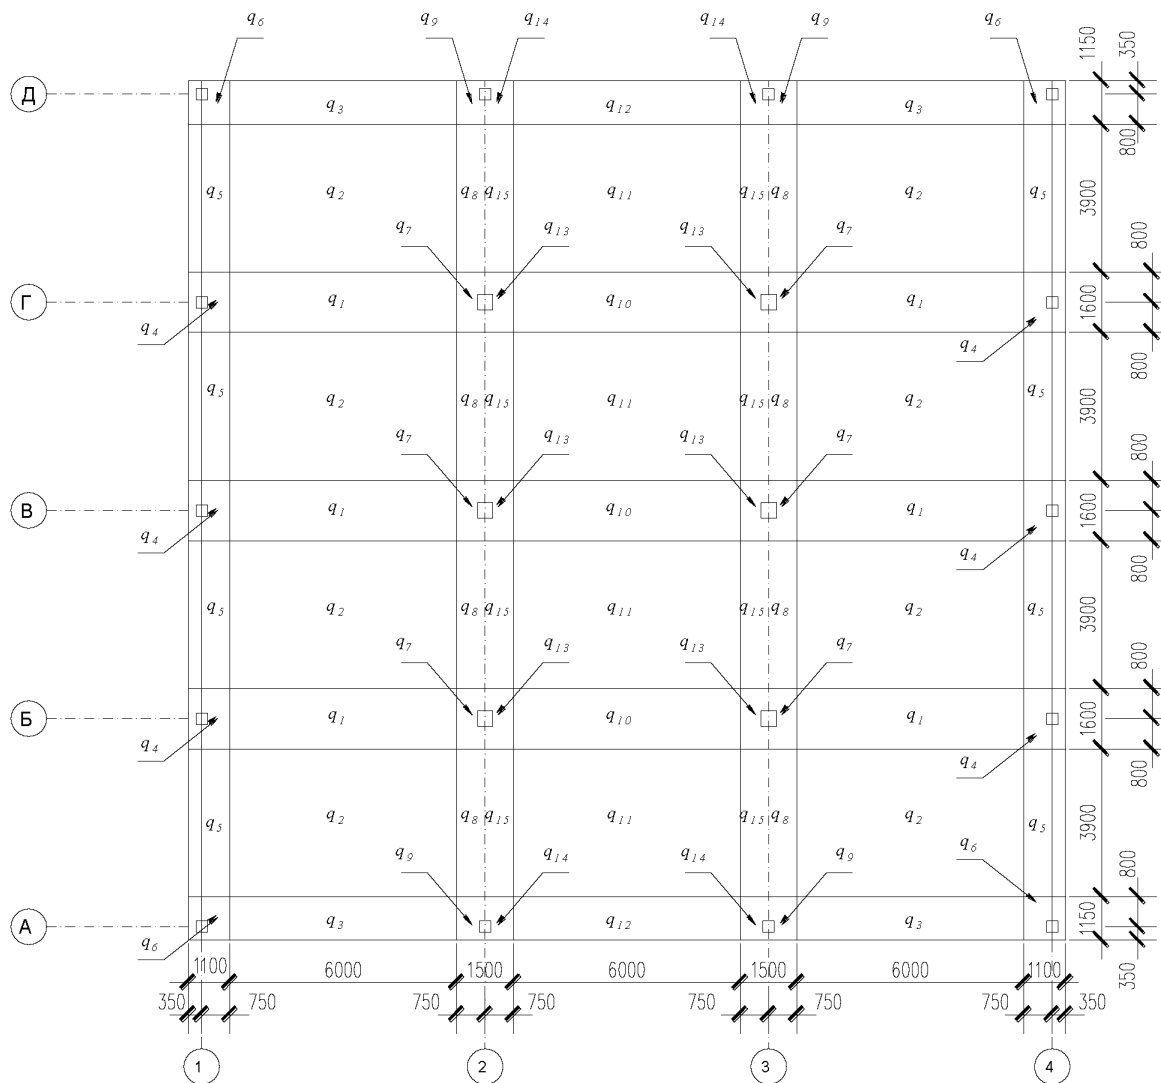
Схема приложения дополнительных вертикальных нагрузок от действия усилий обжатия вдоль буквенных осей
